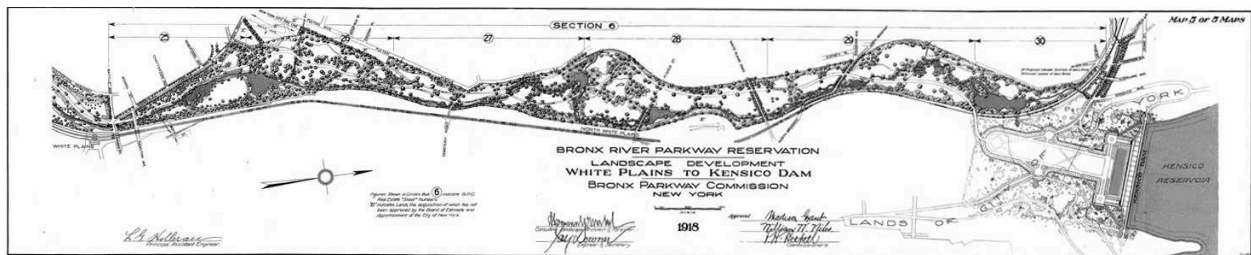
Planimetria di un tratto della Bronx River Parkway, dai disegni originali (Fonte: www.westchesterarchives.com)
